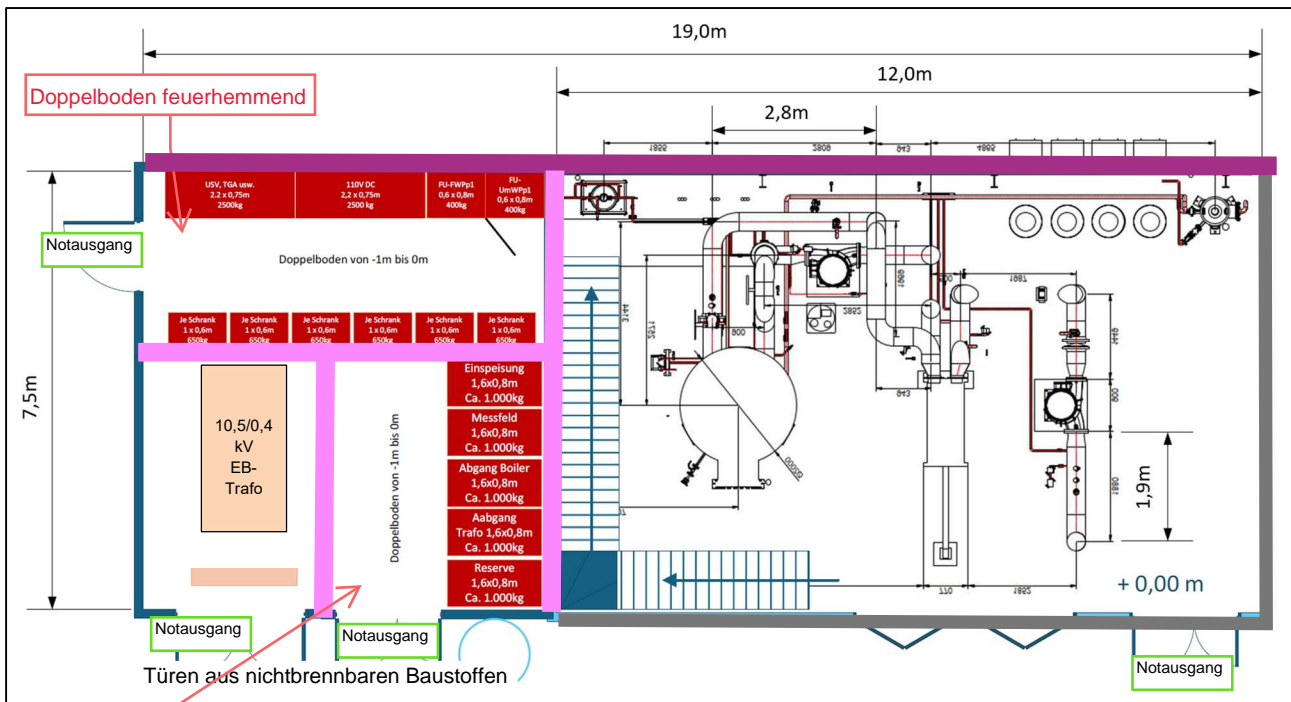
Grundriss Gebäude (dunkelbau Massivbau, hellblau Stahlskelettbau)
